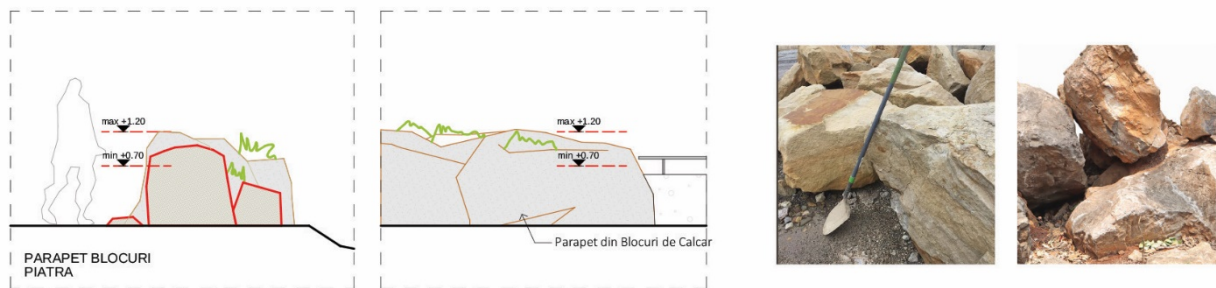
Parapeți realizați din blocuri de piatră cu fundații de beton
